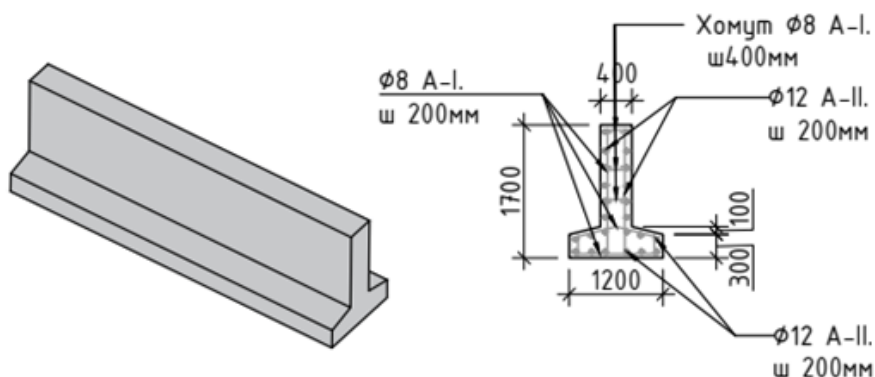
Конструкция донной стенки для фиксирования проектных отметок дна русла
